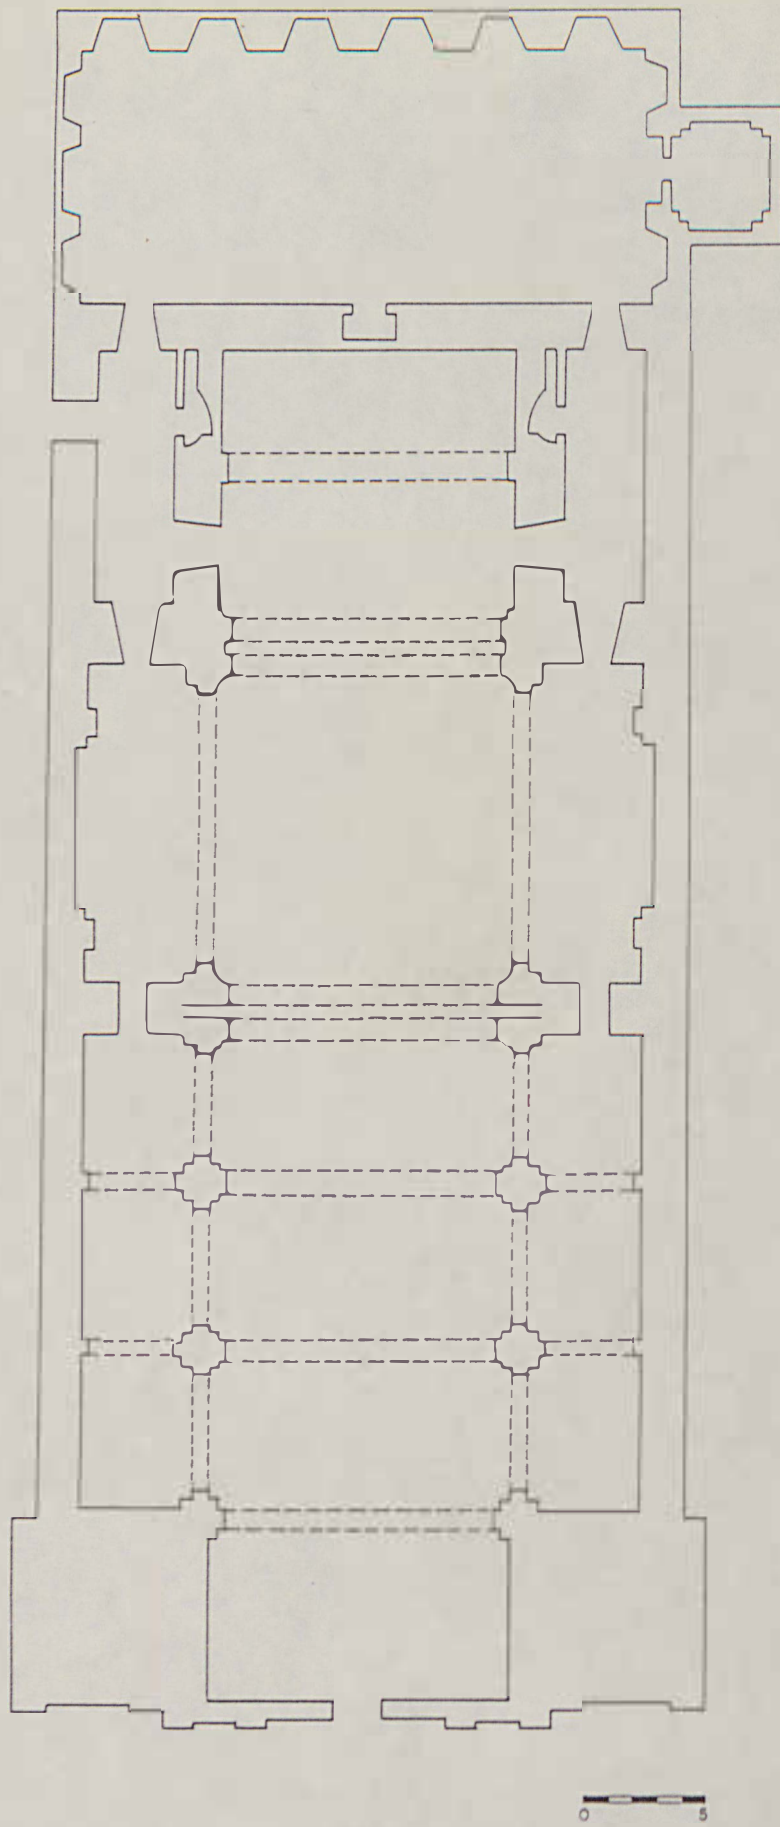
Proposta para planta baixa da Nova Igreja
